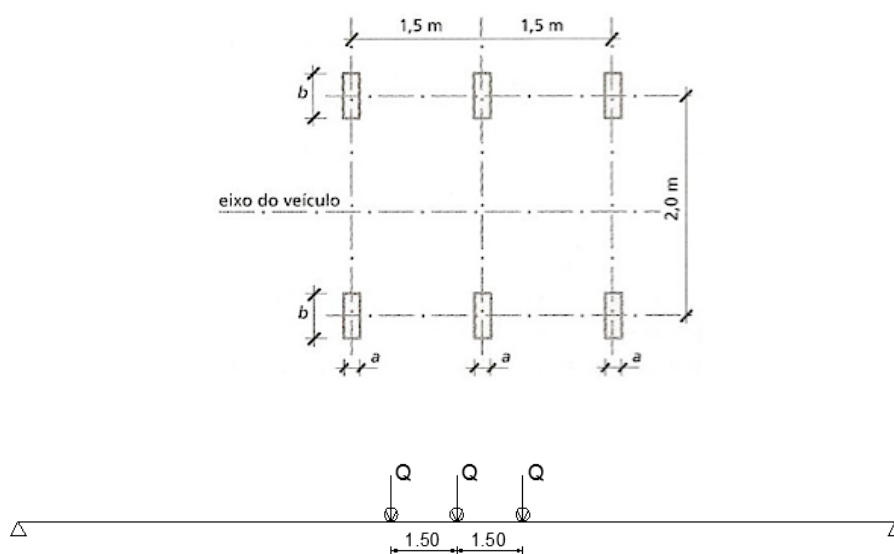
Veículo-tipo segundo o RSA: em planta [5] (em cima) e em perfil longitudinal (em baixo) sobre um tabuleiro simplesmente apoiado.
